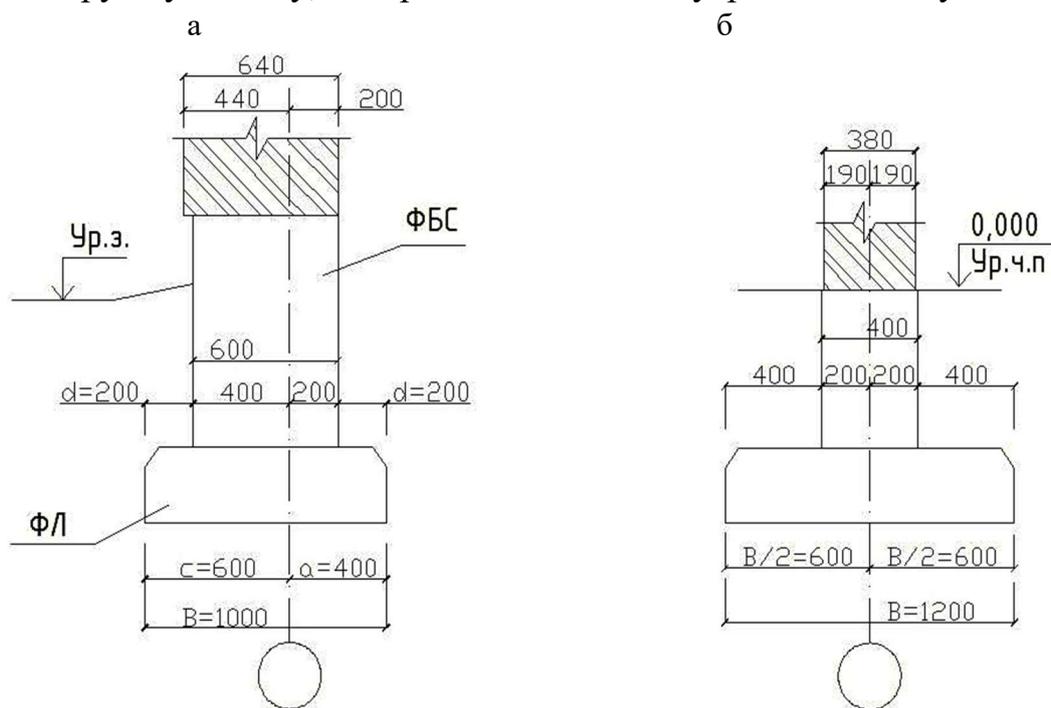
Пример расчета привязки фундаментной плиты:
